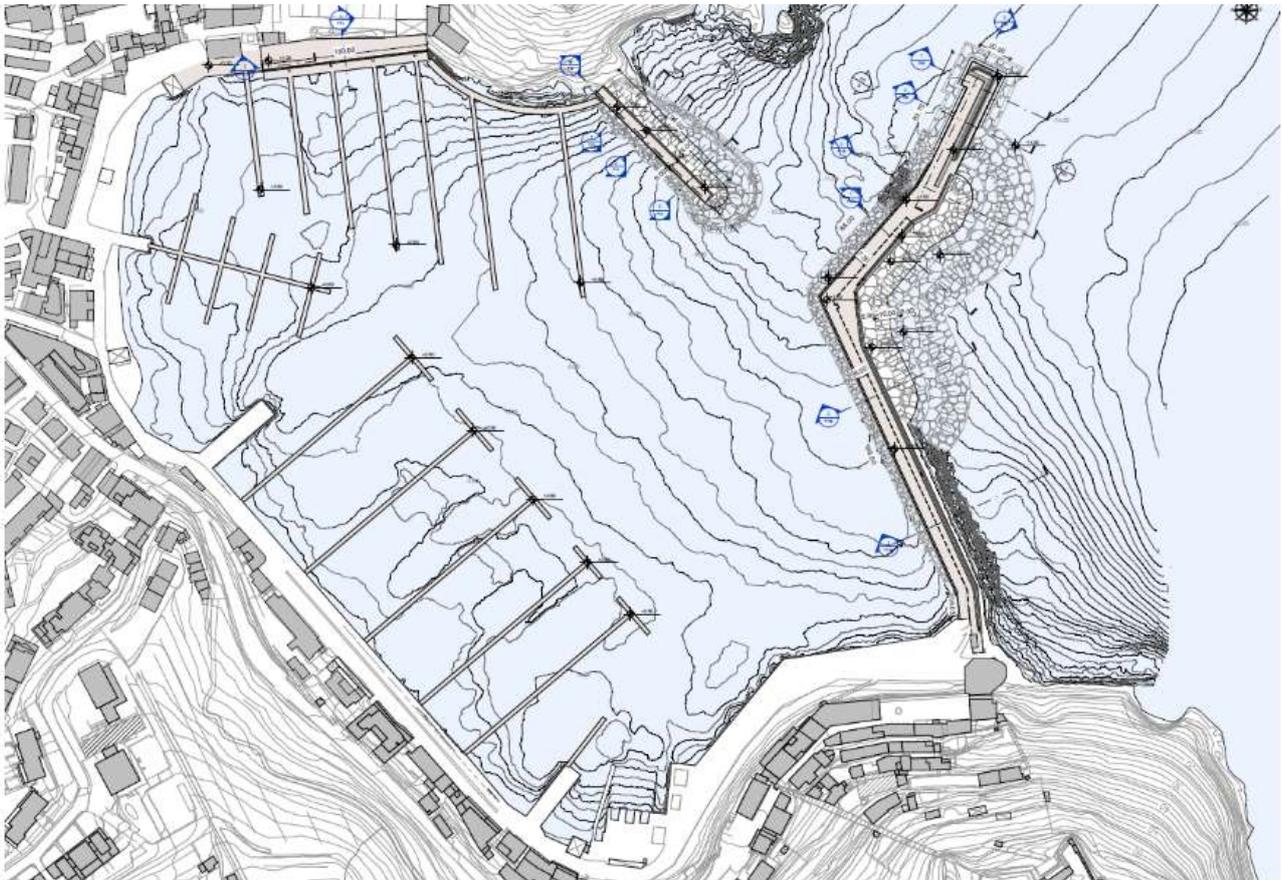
Planimetria generale con ipotesi di distribuzione dei pontili galleggianti per l'ormeggio
